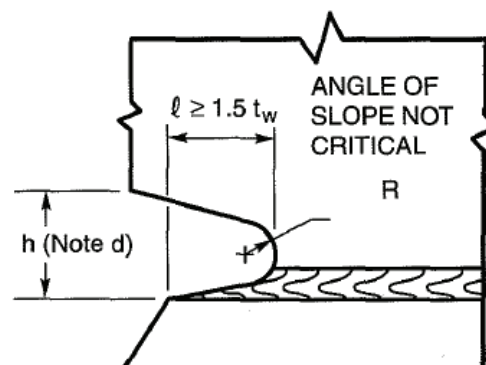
Diseño de un acceso de soldadura u orificio de ratón³⁴
